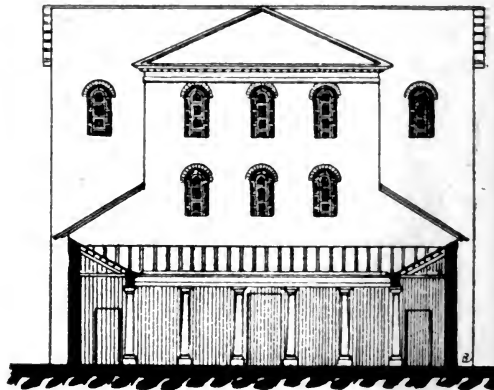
FAÇADE ET COUPE SUR L'ATRIUM D'UNE BASILIQUE LATINE.
